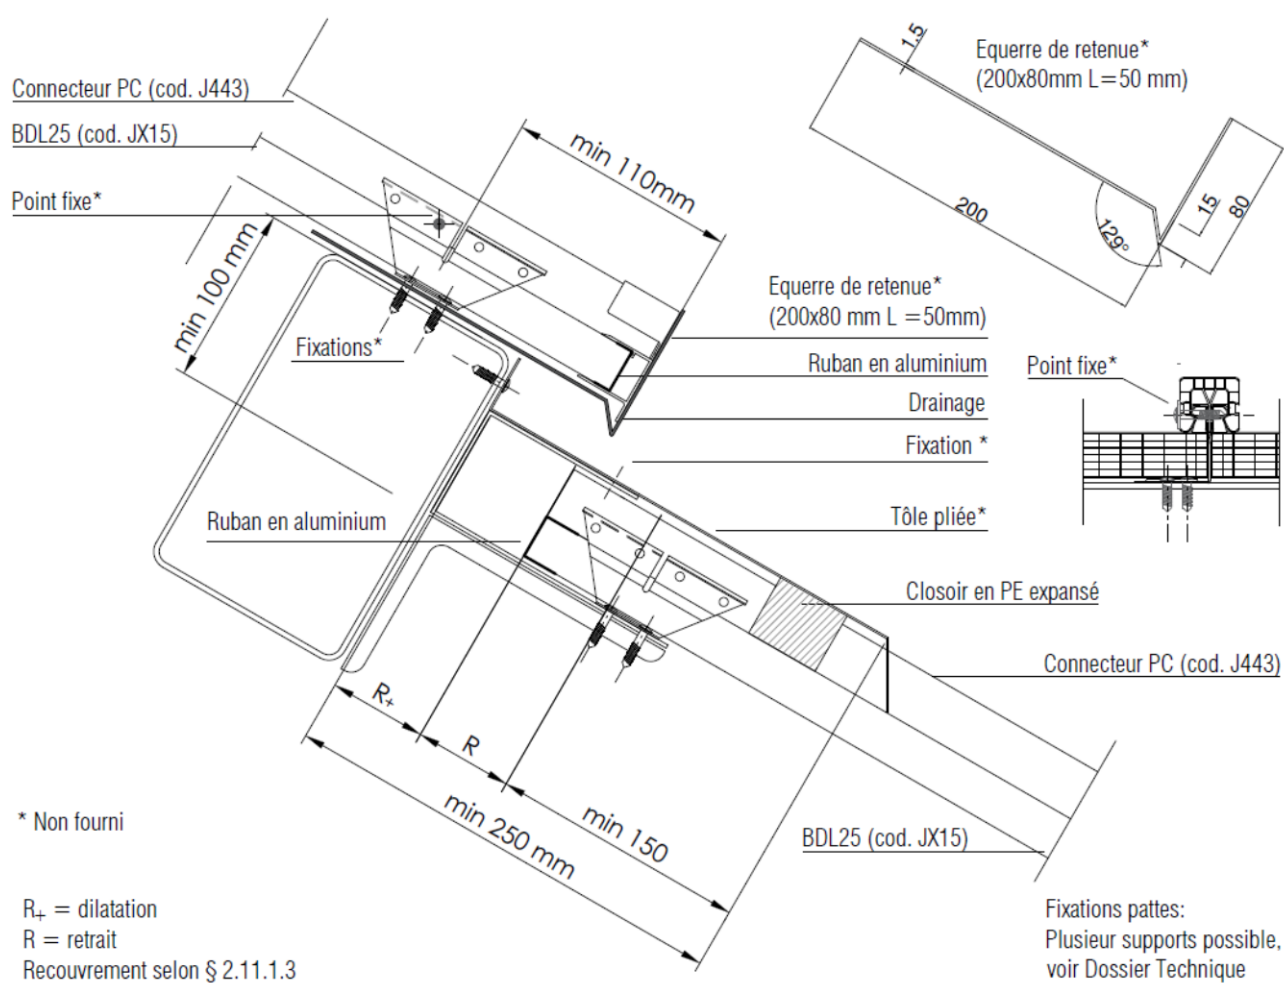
Raccordement sur le mur - Pose avec point fixe bas
